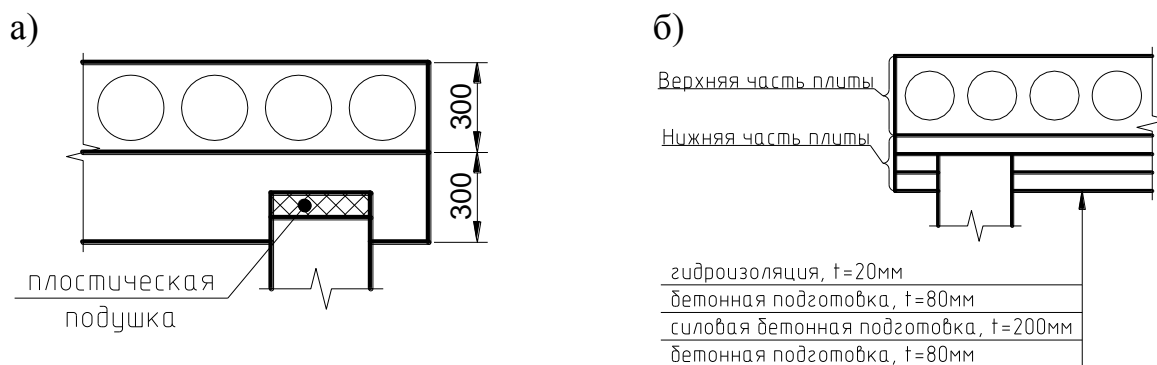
Конструктивные схемы плитно-свайных фундаментов с пластической (а) и силовой бетонной подготовкой (б)
